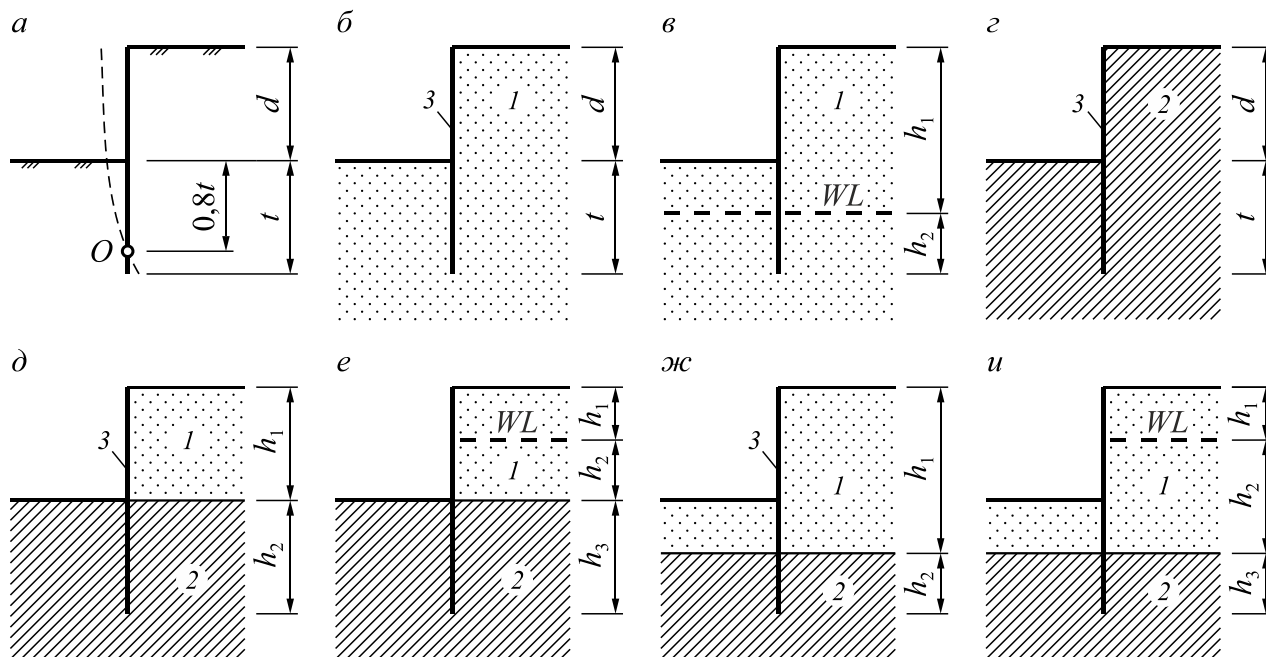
Схема деформирования консольной шпунтовой стенки (а) и варианты грунтовых условий (б – и): 1 – сыпучий грунт ($\gamma_1, \gamma_s, e, \varphi_1$); 2 – водоупорный грунт (γ_2, φ_2, c_2); 3 – шпунт
